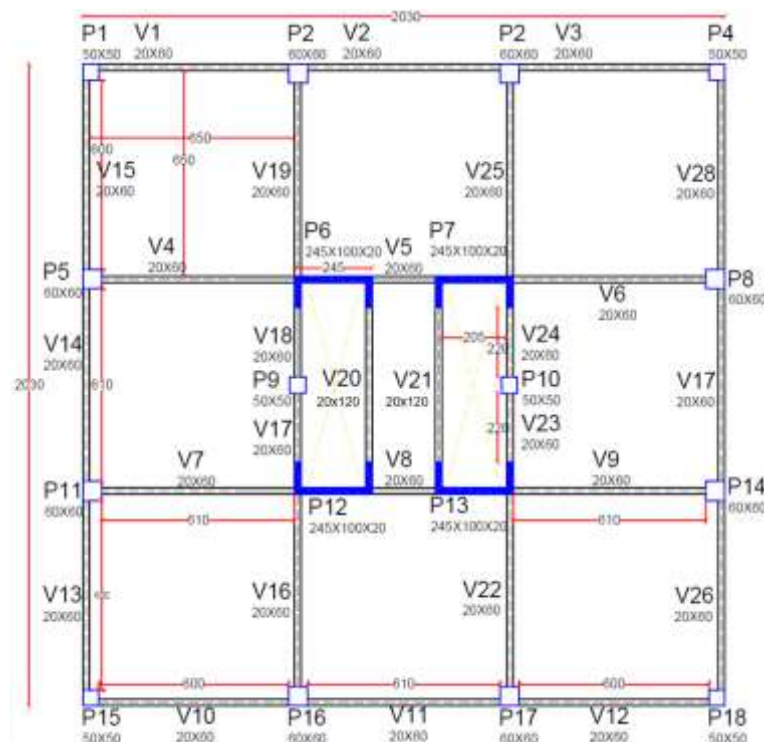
Planta de formas do pavimento tipo, estrutura com núcleo rígido.
